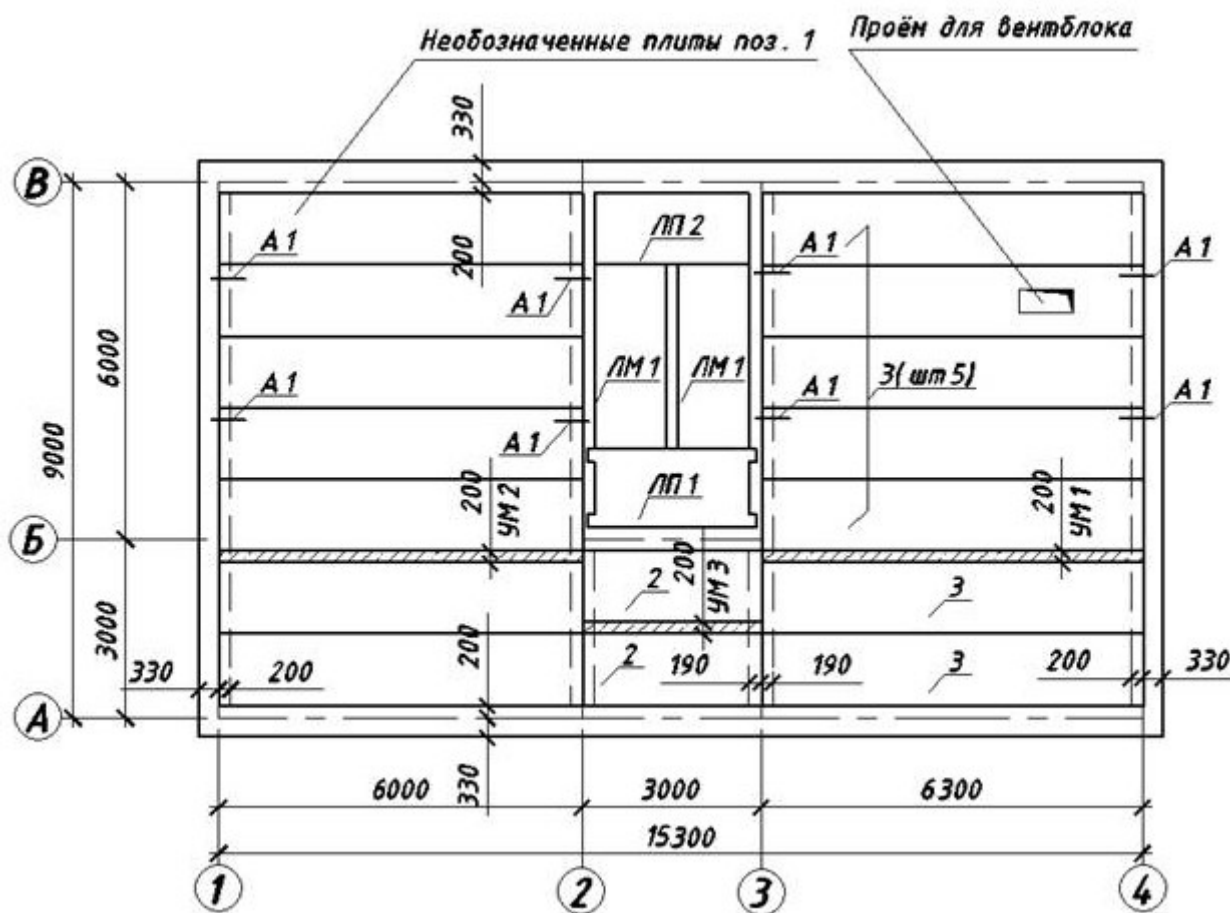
План перекрытий первого этажа малоэтажного дома
